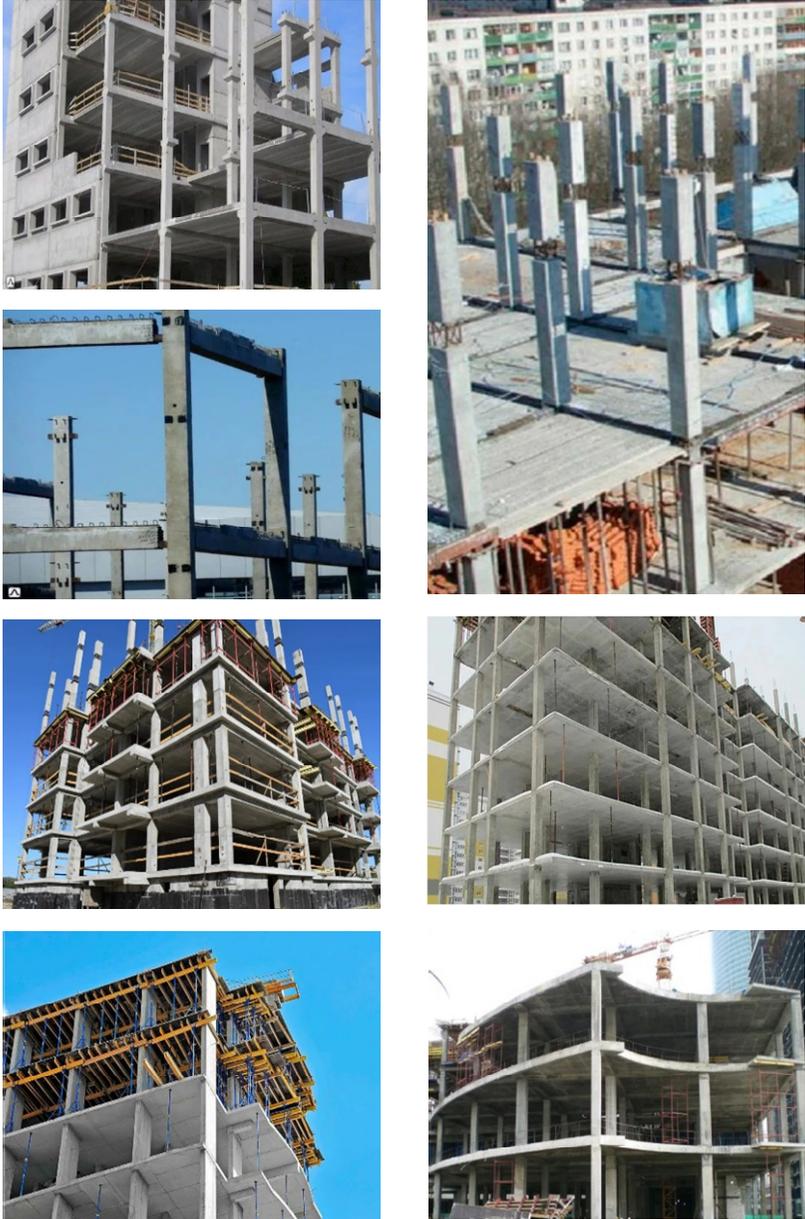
Примеры железобетонных каркасов гражданских зданий
